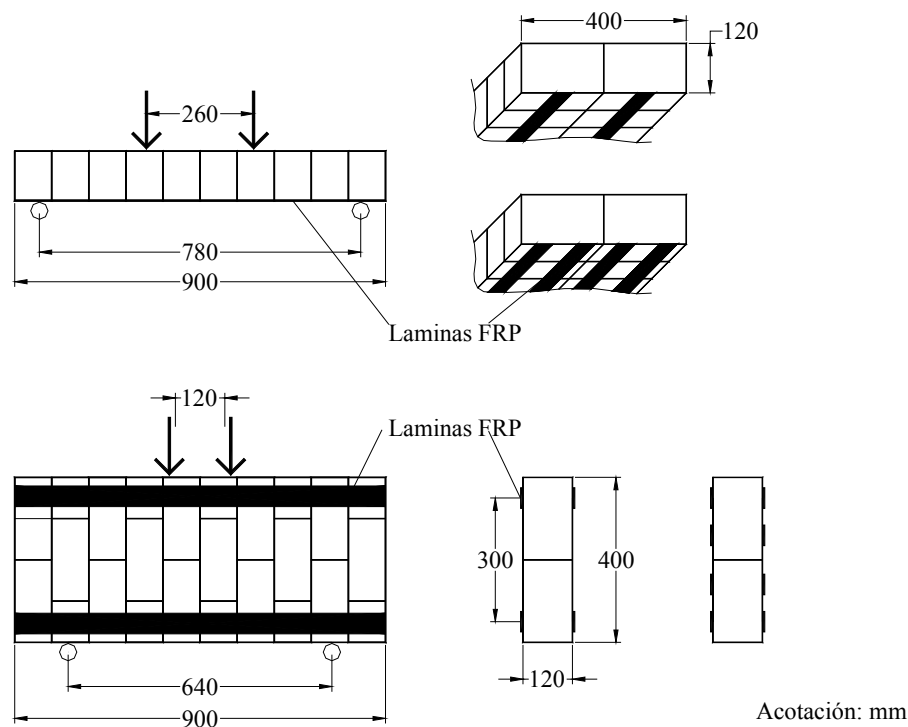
46 — (a) Geometría y configuración de carga aplicada a los paneles; (b) sección transversal de los paneles 1-2a, 12b; (c) sección transversal de los paneles 1-4a, 1-4b (Triantafillou, 1998b).
